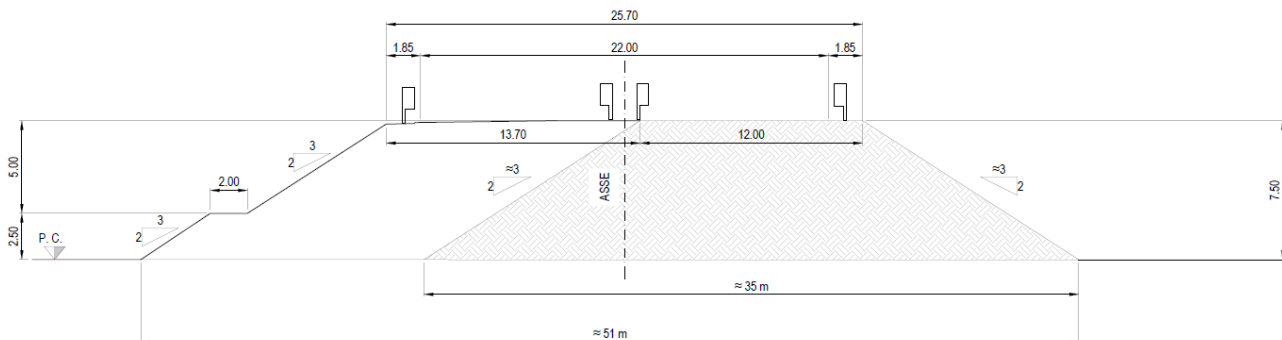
Sezione Tipo B rilevato autostradale in allargamento H = 7.5 m
